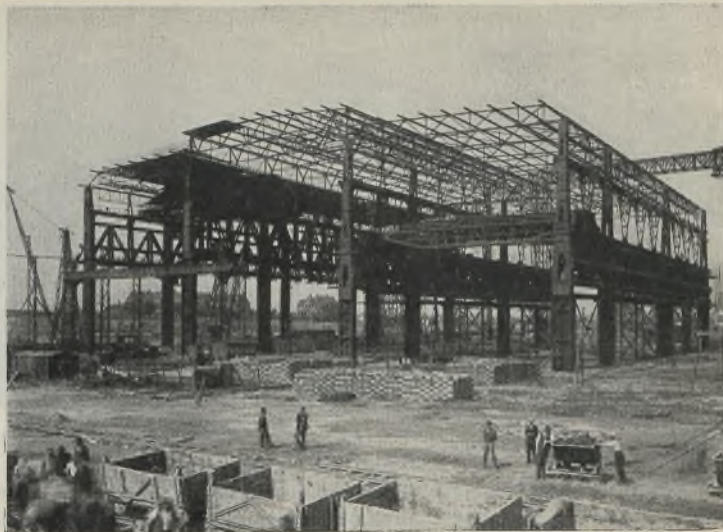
Stahltragwerk des Martinstahlwerks mit fertig aufgestelltem Unterbau.
